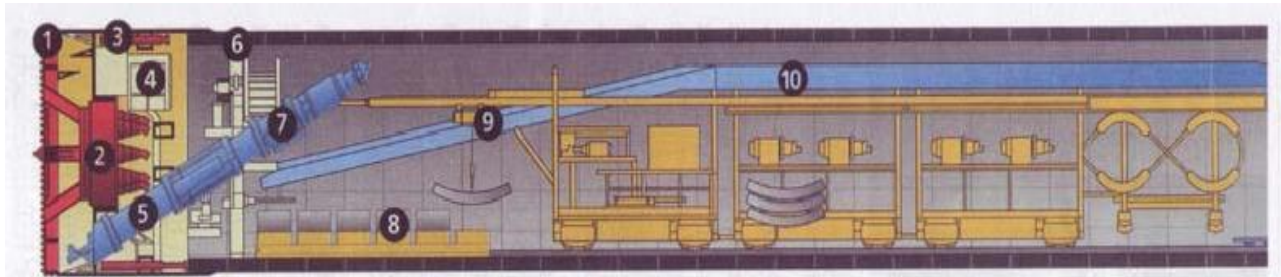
Принципова схема ТПМК із ґрунтовим привантаженням вибою:
